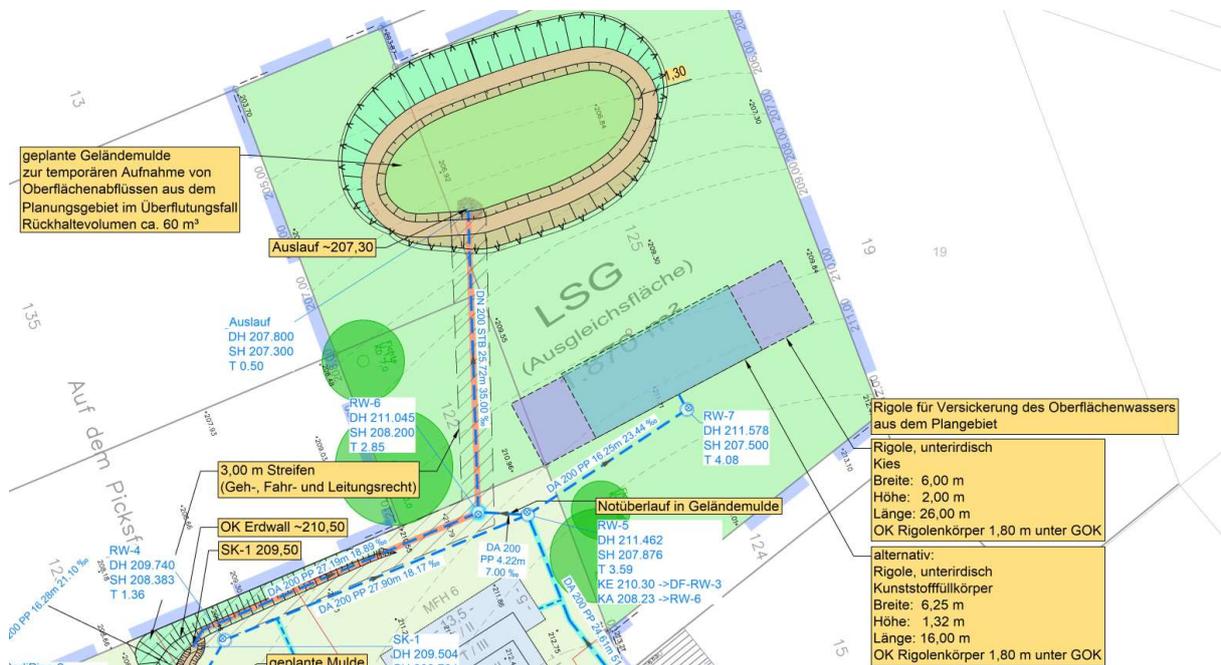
Fachplanung zur Entwässerung, Planausschnitt (Quelle: Ingenieurbüro Brenner GmbH)
